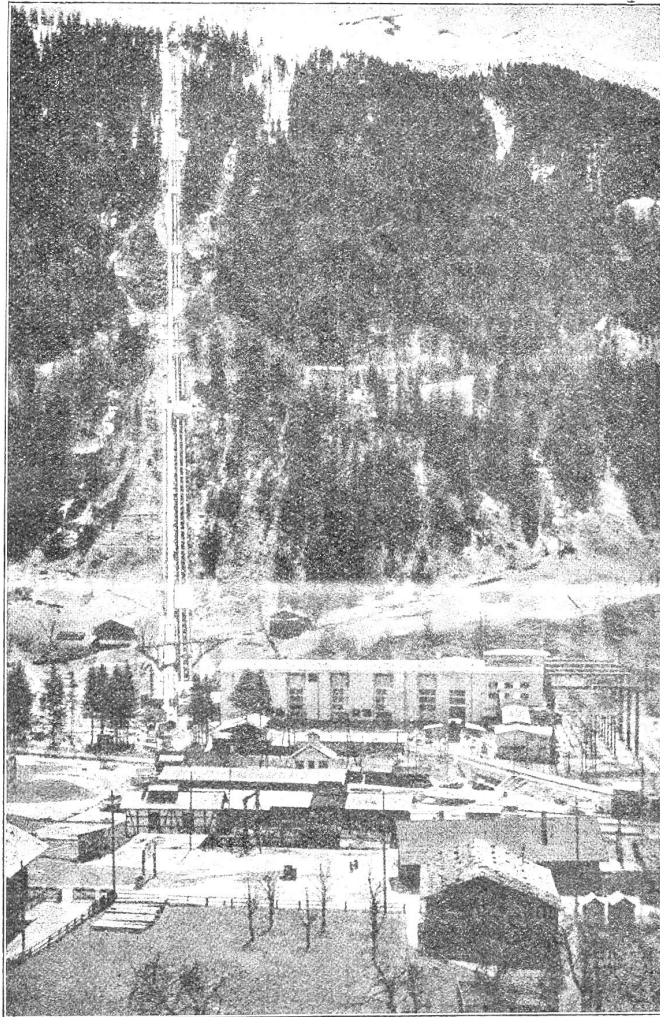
Druckleitung und Maschinenhaus Parthenen; rechts Freiluftschaltanlage.
